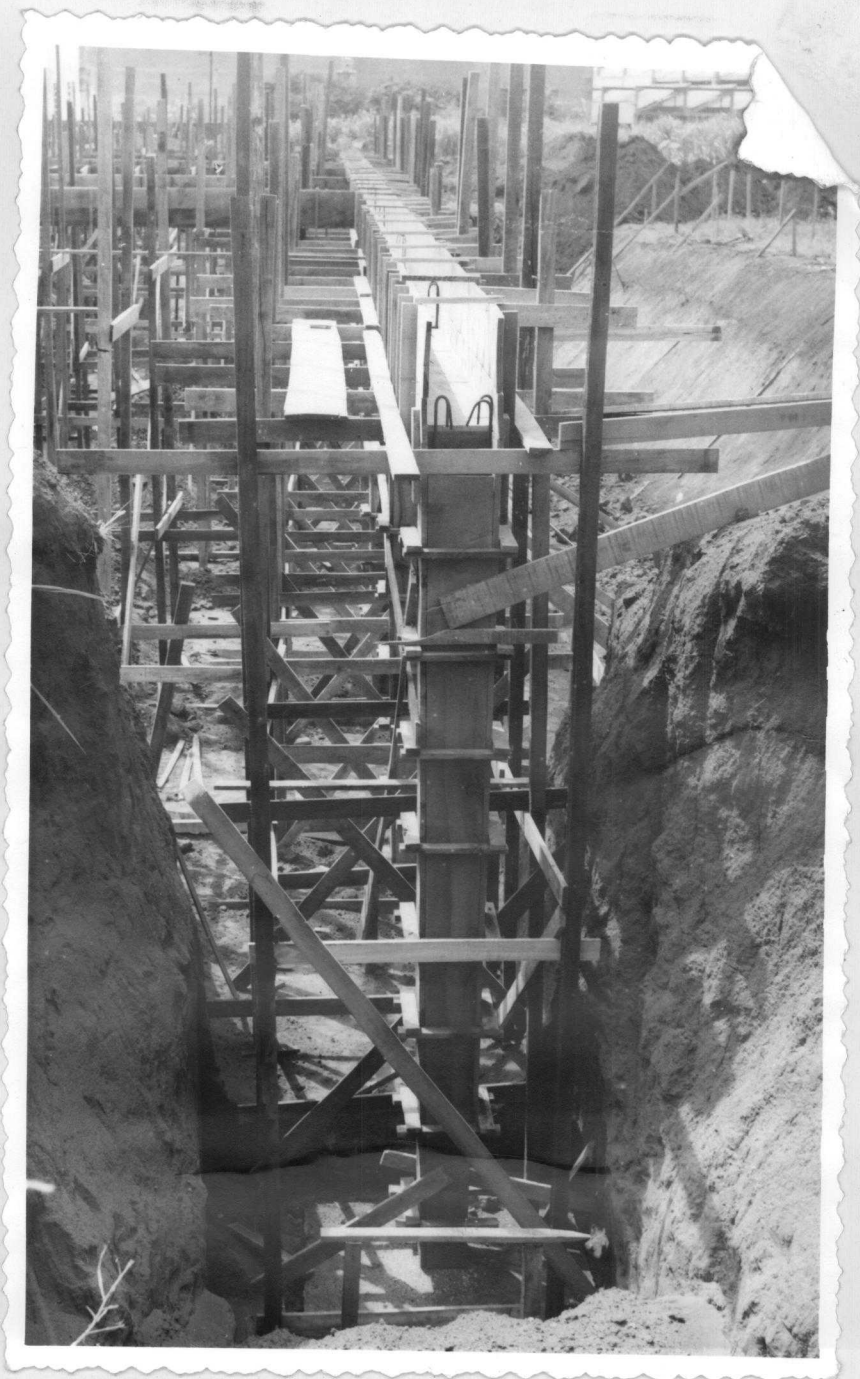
Formas colocadas para concretagem da estrutura interna. Note-se a escavação do talude para permitir a execução dos pilares da extremidade.
